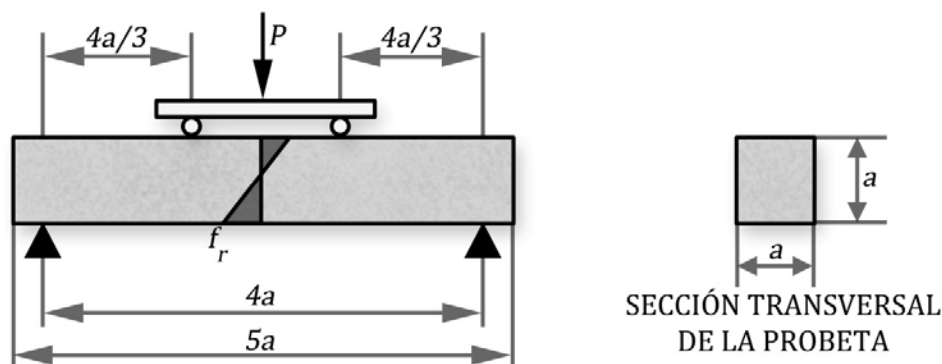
Ensayo estandarizado para la determinación del módulo de rotura del hormigón
